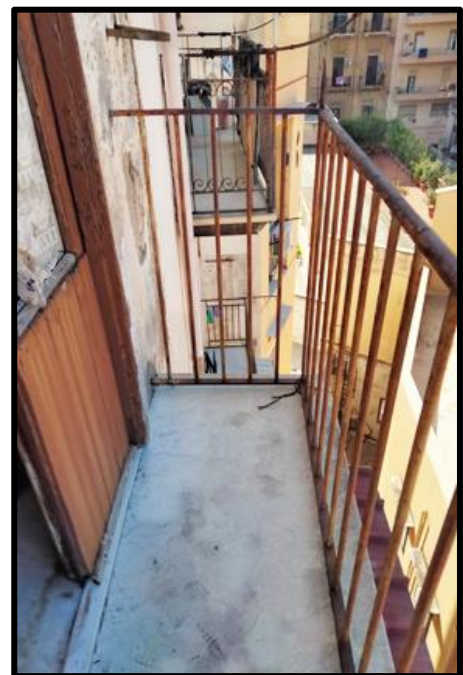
Vista del balconcino con affaccio sull'atrio interno.
